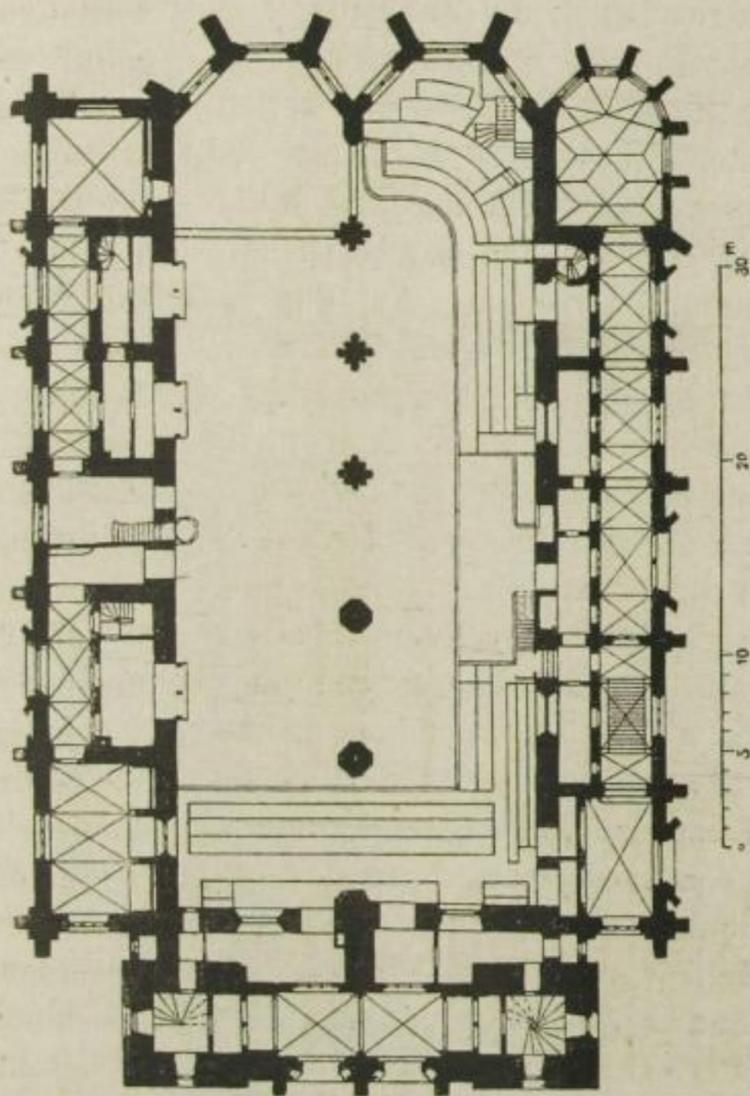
Grundplan der Sophienkirche nach der Restauration. (Architekt Arnold.)
